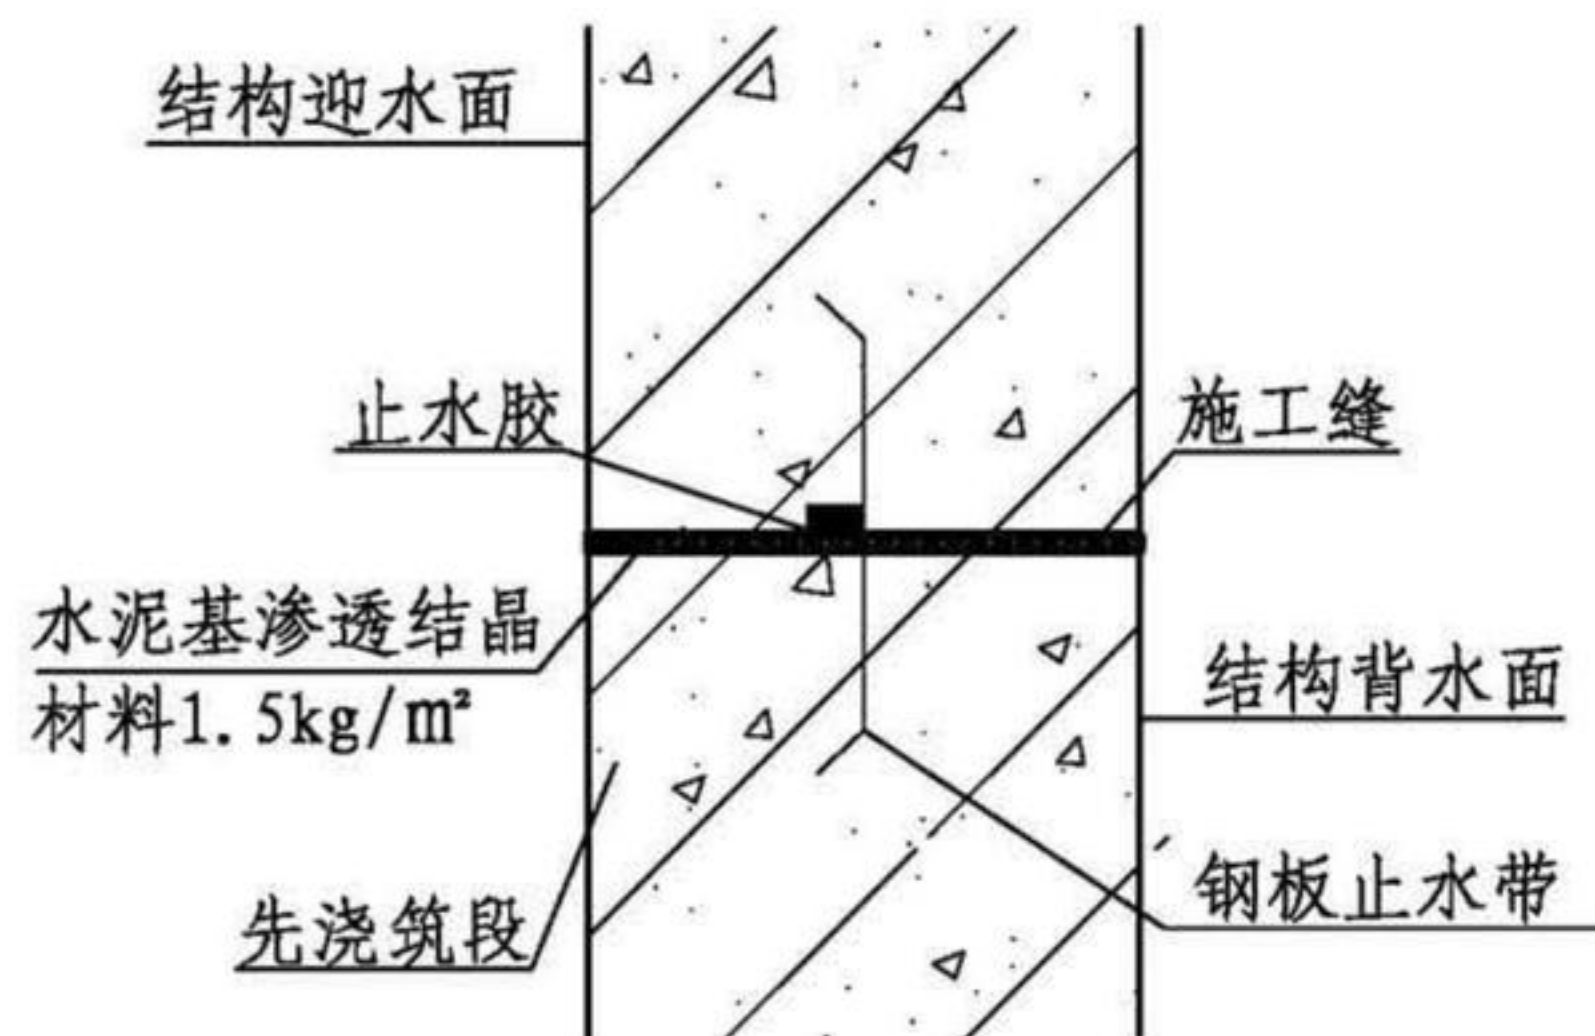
侧墙（纵向）施工缝防水构造示意图（二）
